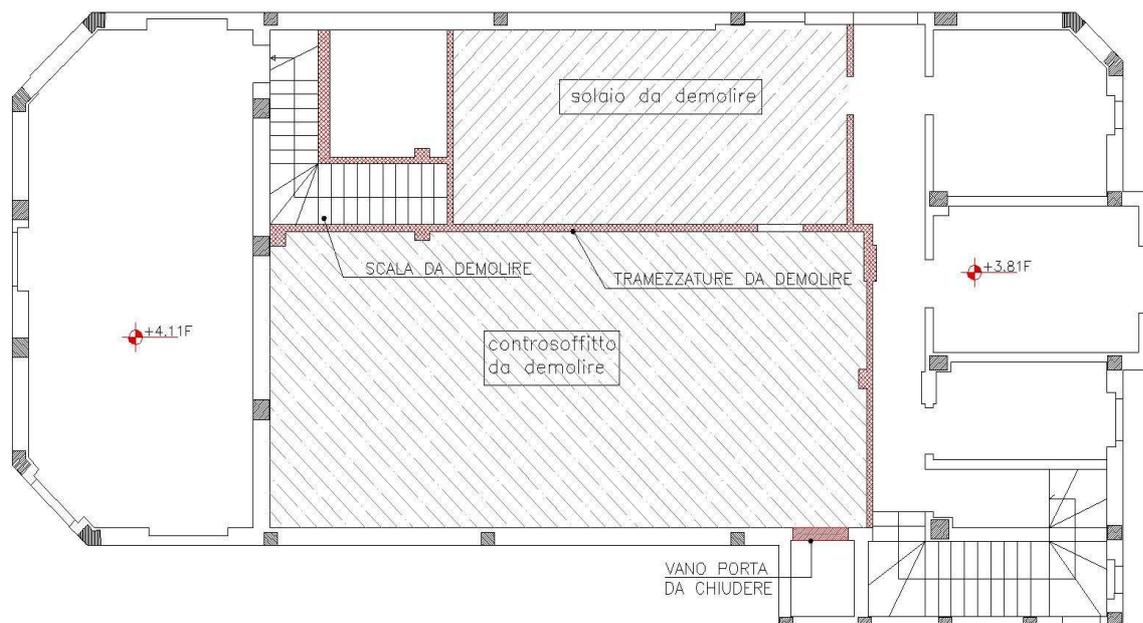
interventi parziali di demolizione del solaio al piano primo
